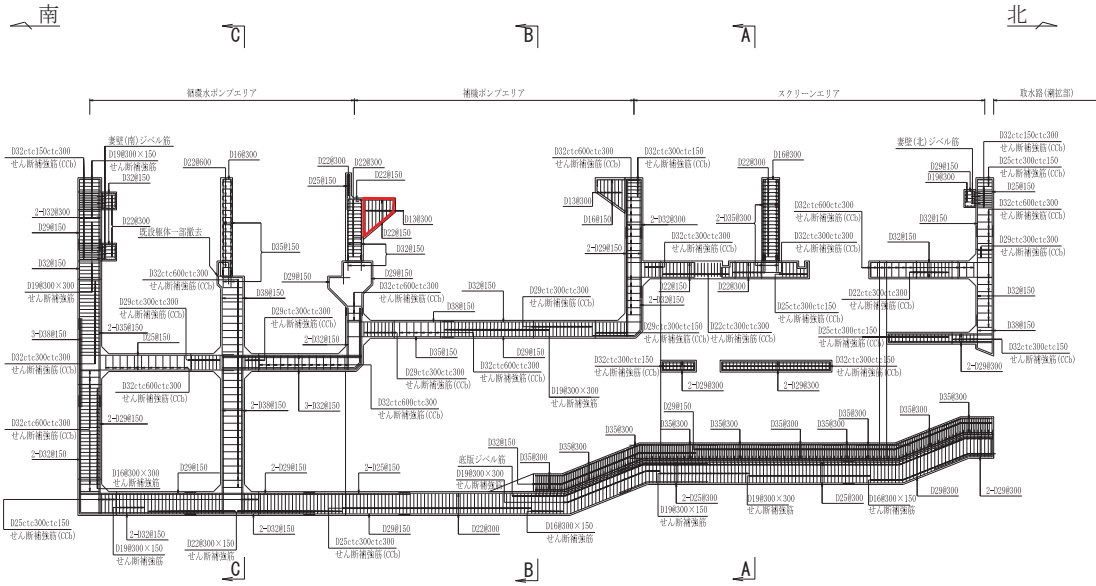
海水ポンプ室概略配筋図 (C-C 断面)
